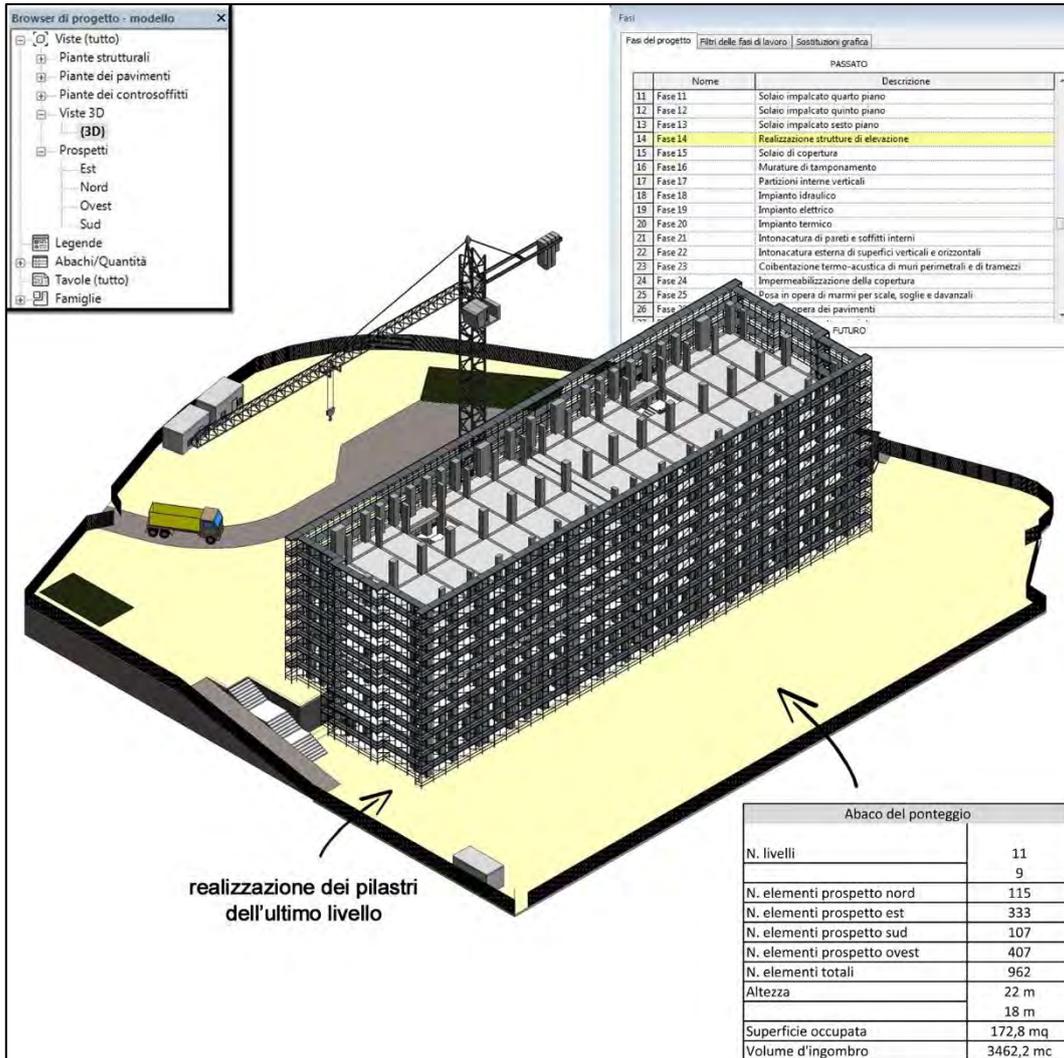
Assonometria della fase di realizzazione dei pilastri dell'ultimo livello
